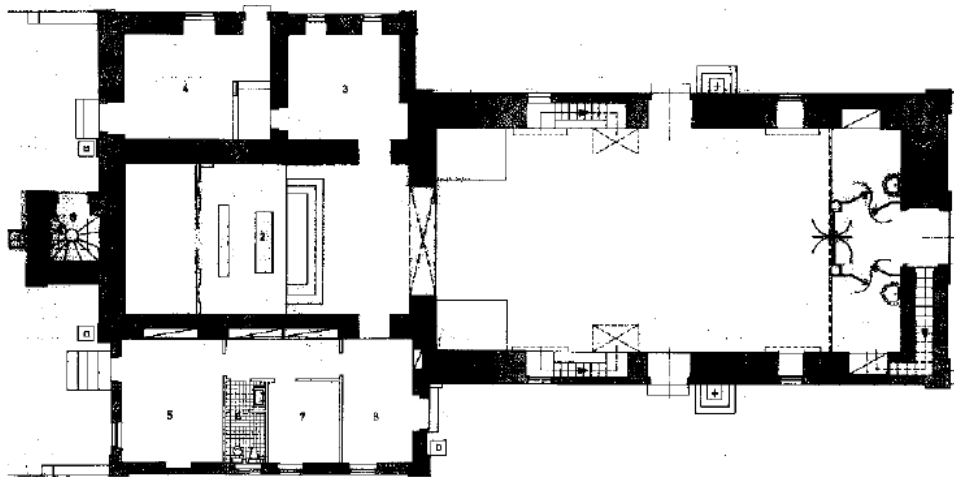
Planta da igreja de São Miguel de Nevogilde (Porto) [3]
